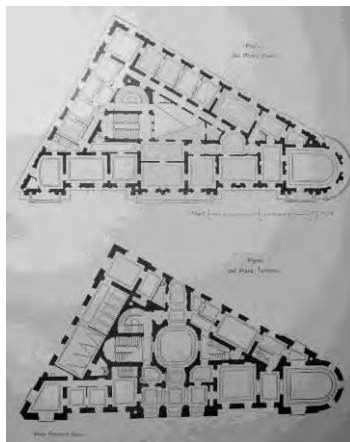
palazzo De Parente piante del piano terreno e del primo piano da "L'Edilizia Moderna", 1899
